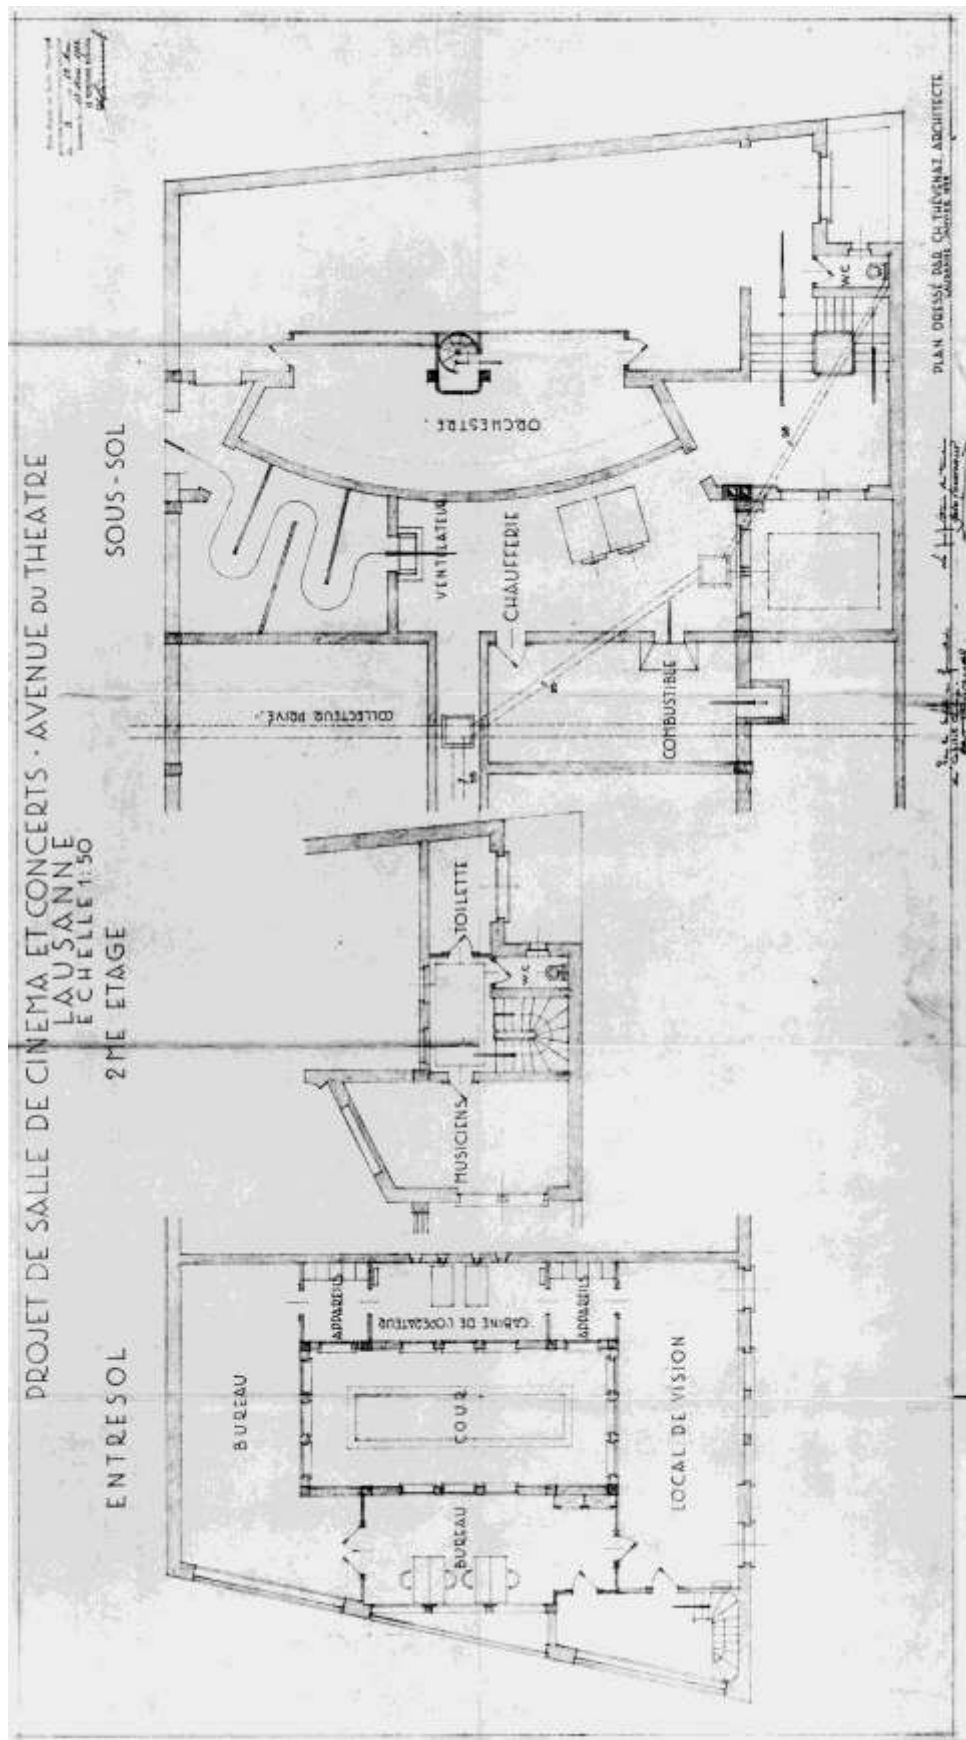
Plans du 1^{er} étage de la salle, du 2^e étage de l'annexe et du sous-sol, Charles Thévenaz architecte, janvier 1928 (AVL).
